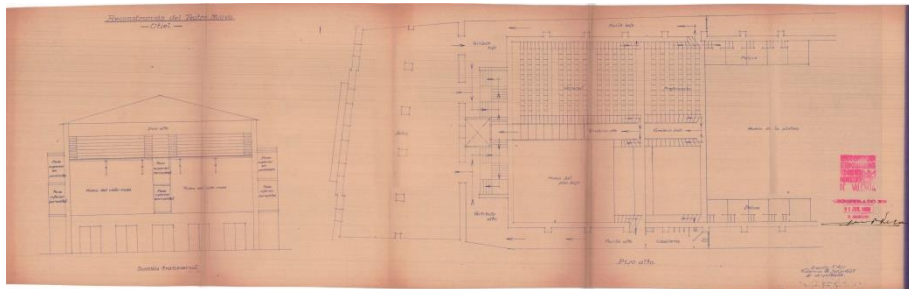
Lámina que incluye la sección transversal y plano planta superior de la reconstrucción del Teatro Rambal
